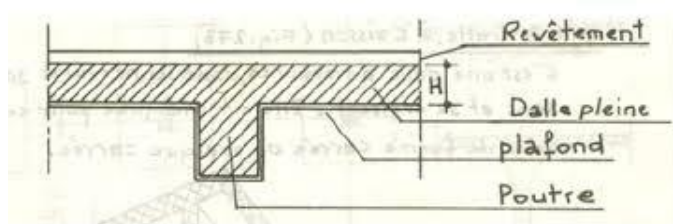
Coupe verticale de plancher courant à dalle pleine.
